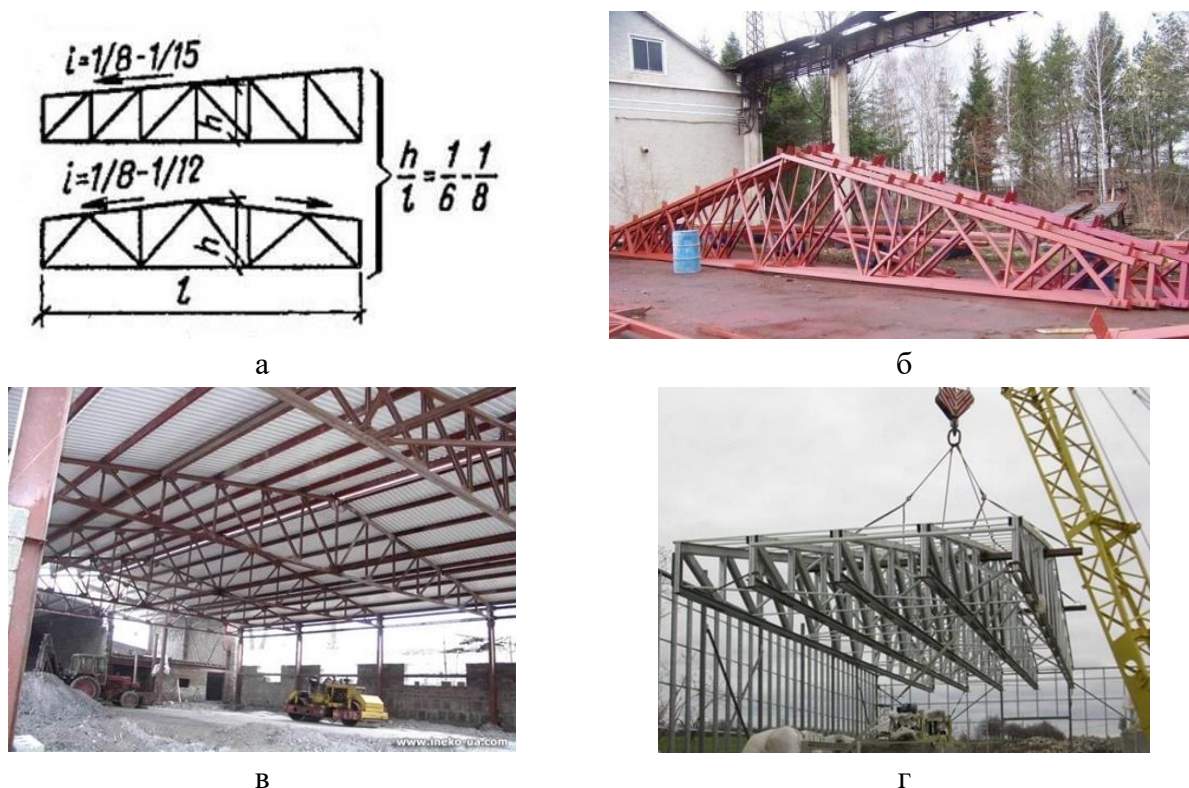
Трапецієподібні ферми: а – схеми ферм; б – готові ферми; в – збудовані покриття з трапецієподібними фермами; г – монтаж ферм
